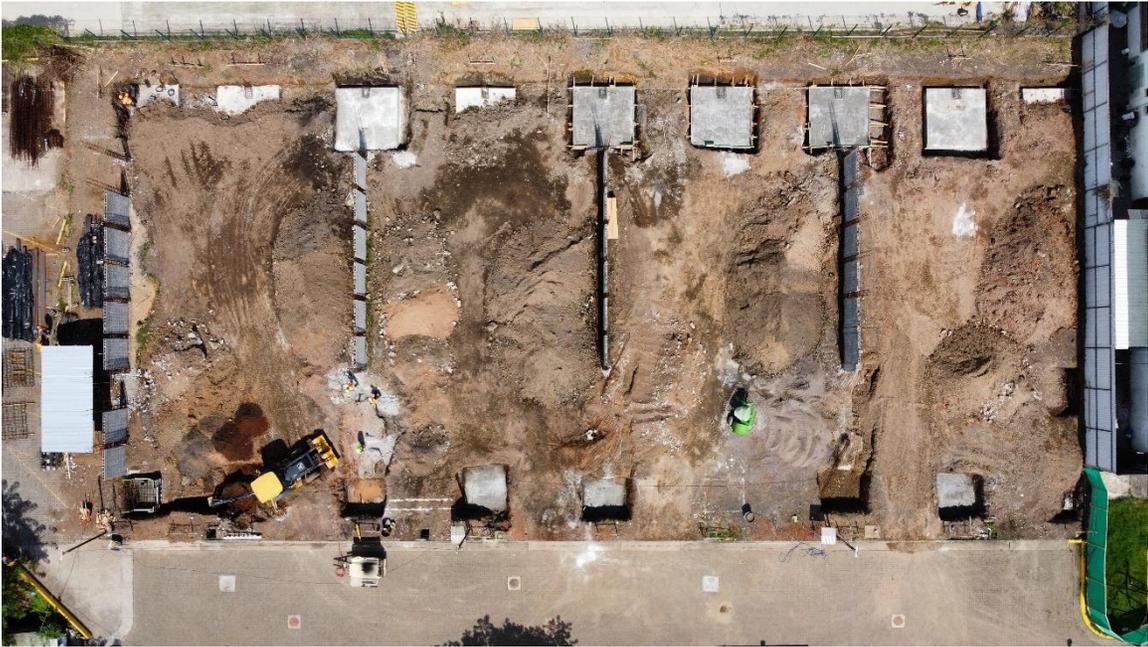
Placas aisladas y vigas de fundación Eje 1 y 2 Proyecto Bodegas Unifika de Lindora.
